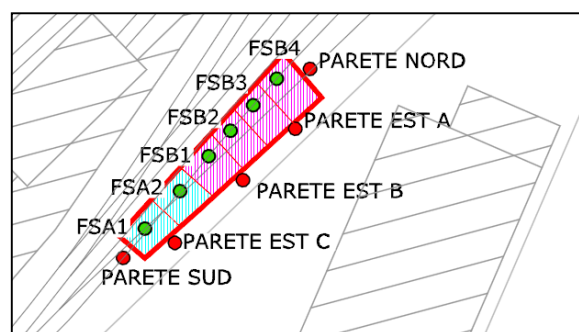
Campioni prelevati dallo scavo e sondaggi eseguiti – Fase 1
